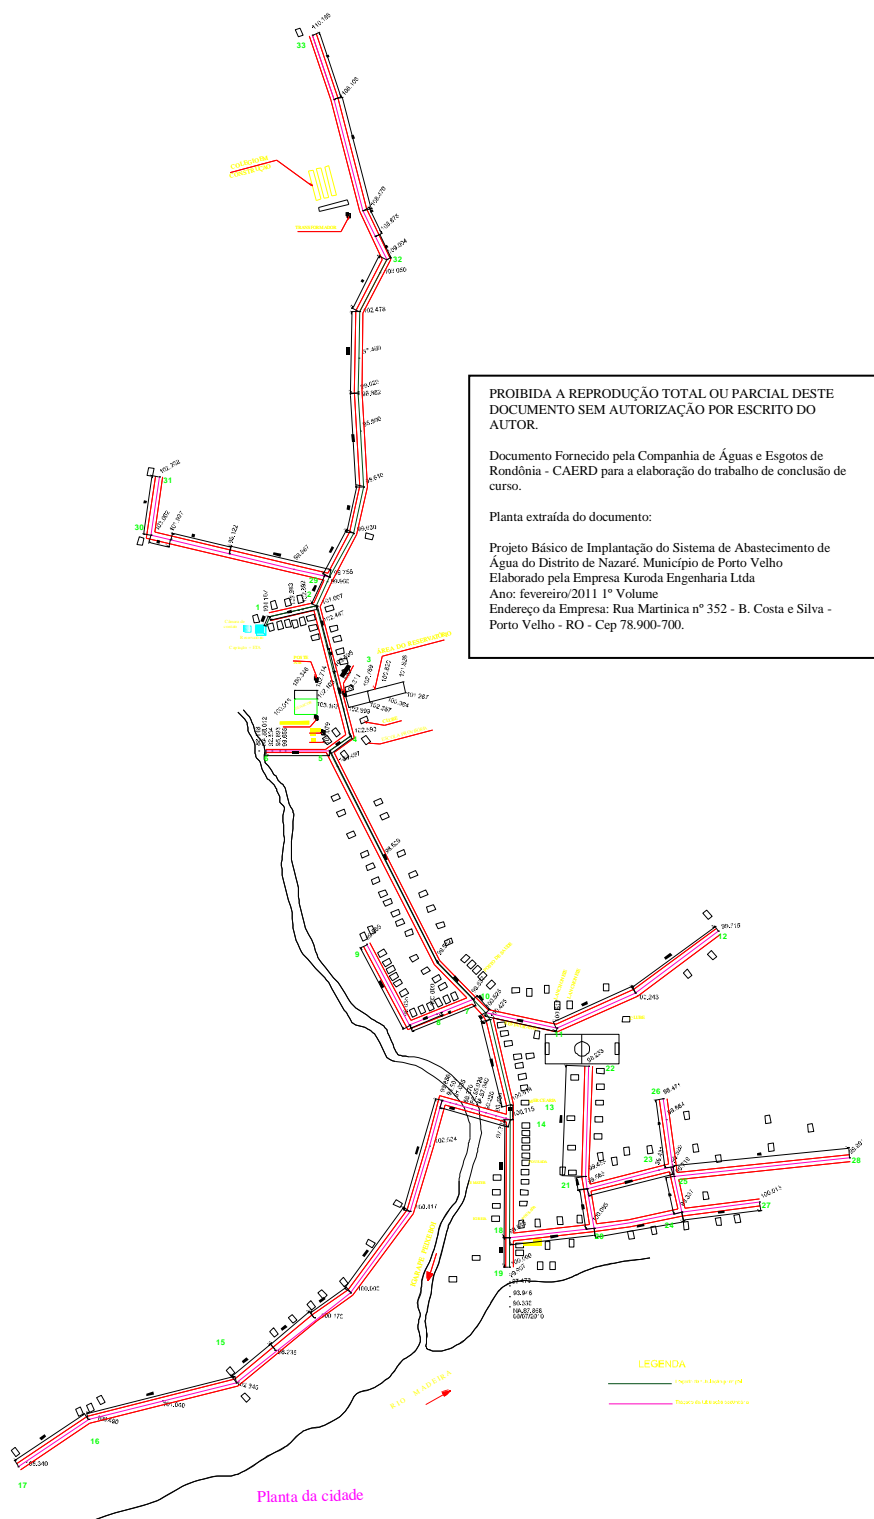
Planta da Comunidade Ribeirinha (Planta Fornecida pela CAERD) – Planta em A1 em Anexo
